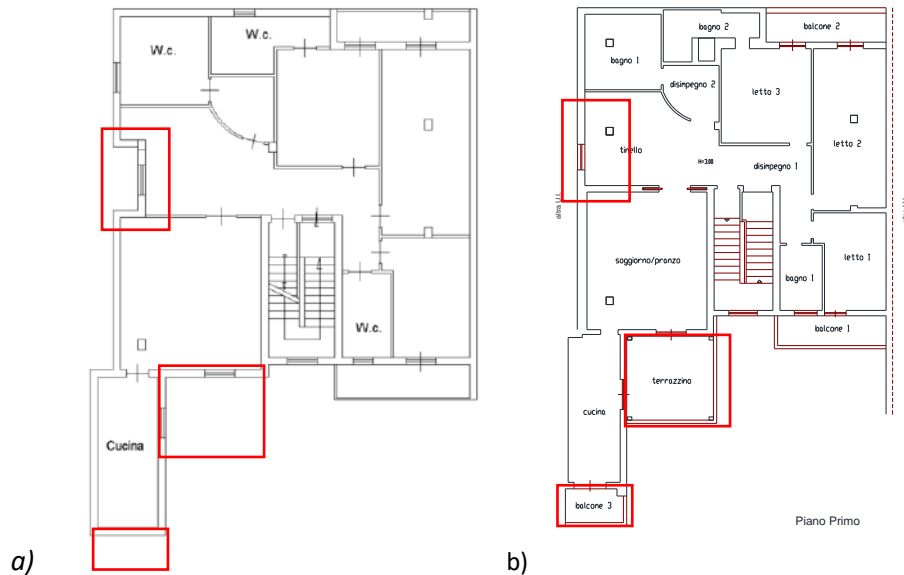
primo piano: a) planimetria catastale; b) planimetria stato di fatto
